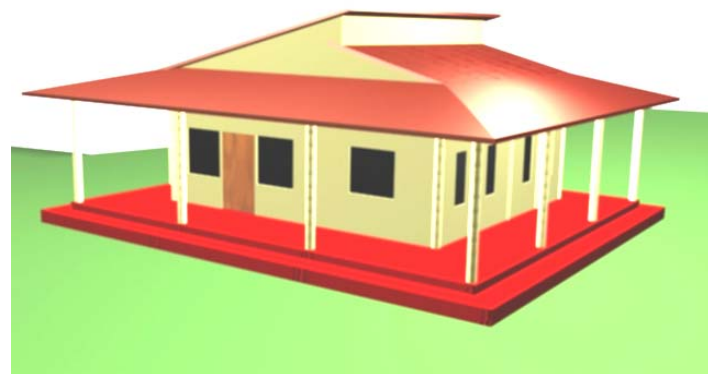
Sistema Construtivo. 6º passo : cobertura e acabamentos finais. (Fonte: Maquete eletrônica de Janderson de Oliveira).
